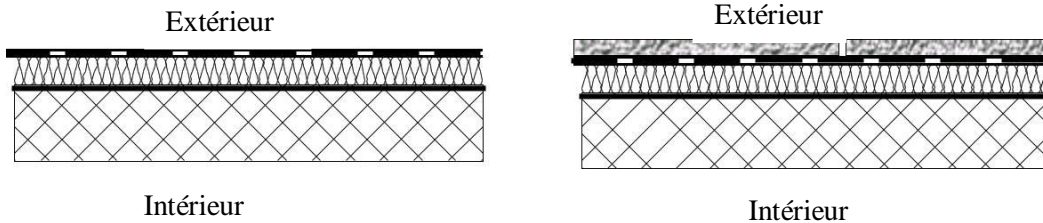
Dalles toiture plates classiques, à gauche sans protection, à droite avec protection de l'étanchéité. [7]
